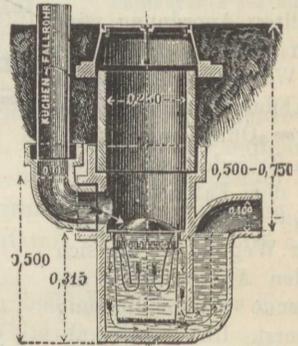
Fettfang am Fuße eines Küchenfallrohres.
